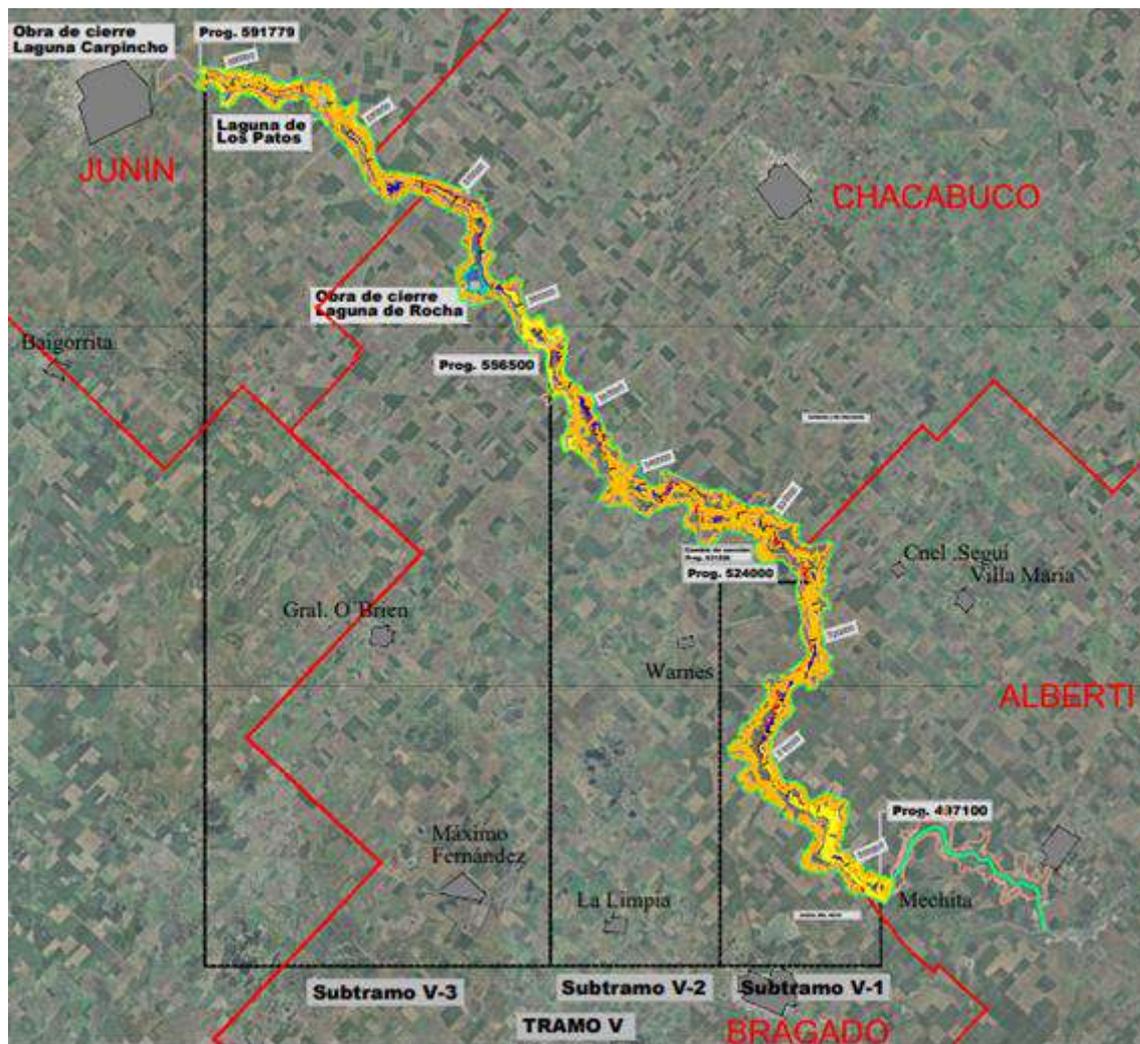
Planimetría del Tramo V. Fte: Departamento Proyectos de Terceros-DPH.2024
